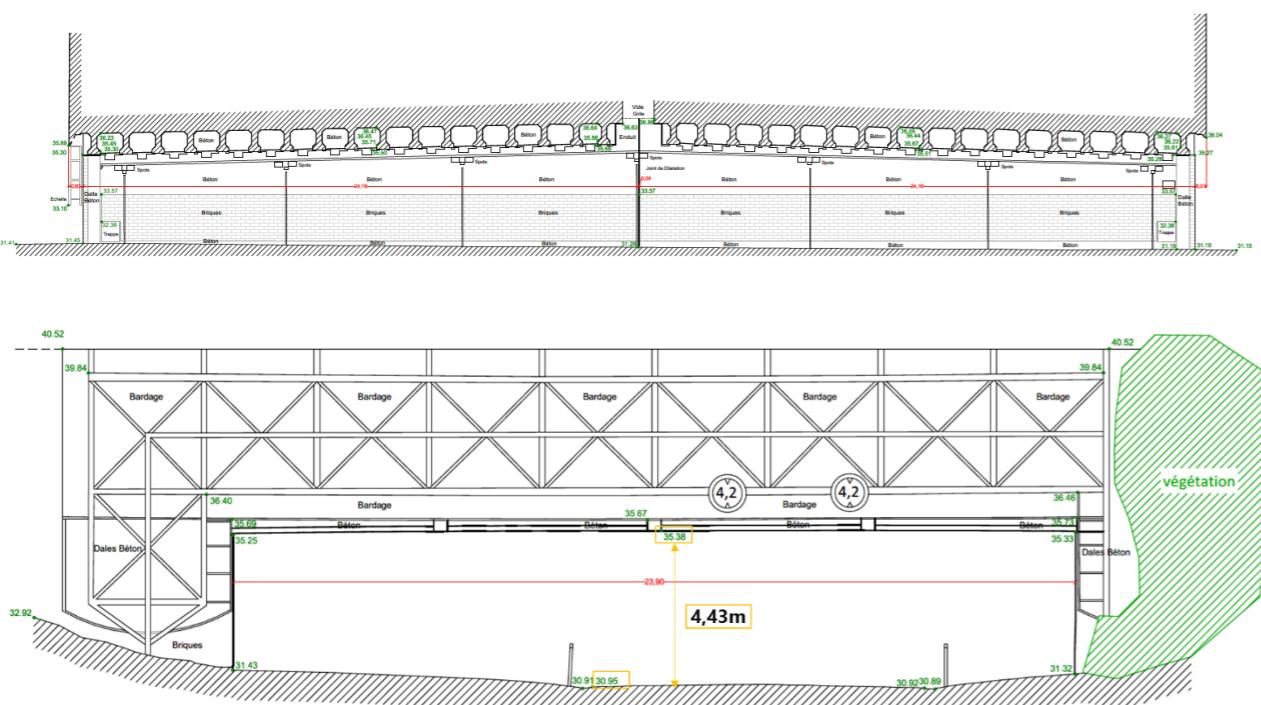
Élévation (haut) et Coupe transversale (bas) de l'ouvrage pont-route de l'A1 franchissant l'avenue Jeanne d'Arc
